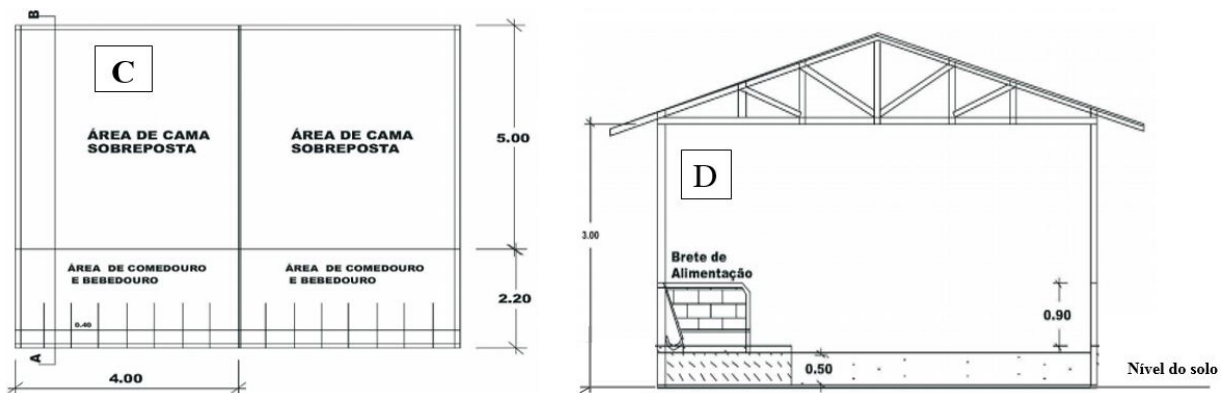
(C) Exemplo de planta baixa. (D) Corte transversal AB.
